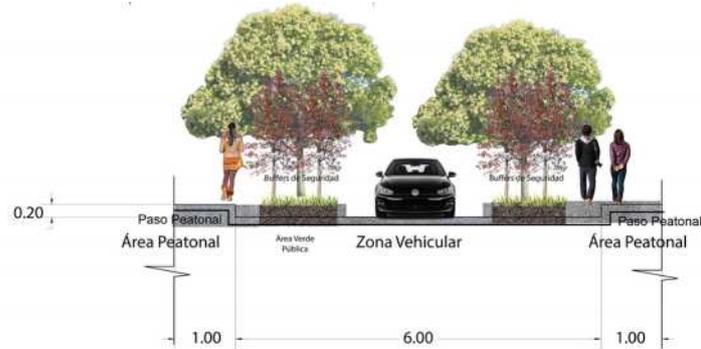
; Corte E-E' propuesta de diseño de paisaje de la Calle Palacio.
